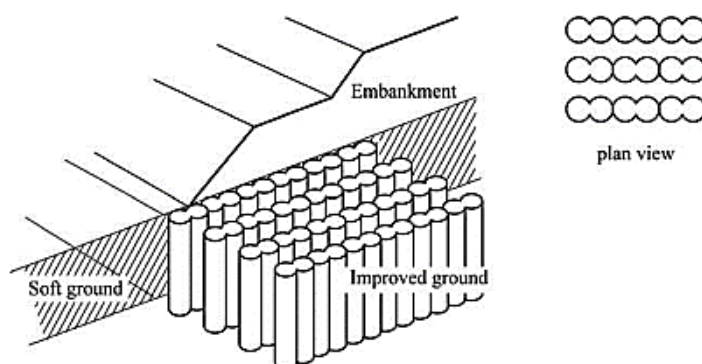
Grupos de columnas en configuración de muros tangentes. (Fuente: Ref. [1]).
